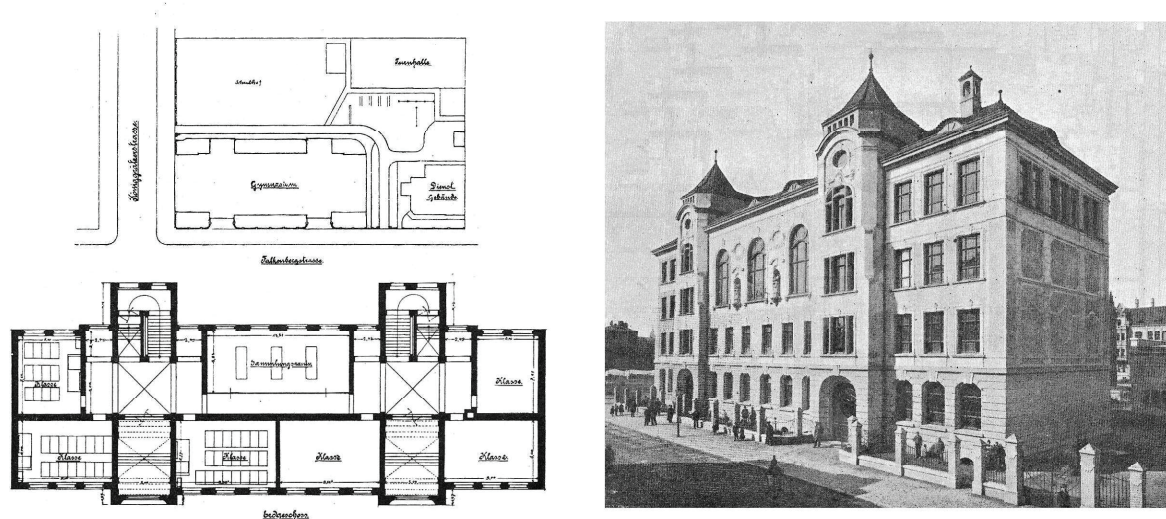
König Wilhelm-Gymnasium in Magdeburg (Bj:1902; Lageplan, Grundriss und Ansicht): viergeschossiger Bau mit 18 Klassen auf Eckgrundstück. Turnhalle (im Nordwesten) und Dienstwohnung (durch Hofeinfahrt getrennt, im Westen) befinden sich auf demselben Grundstück. Einfriedung: Falkenbergstraße (vorne): Zaun mit Sockel, Königgrätzerstraße (Schulhof): durchbrochene Mauer mit Dachsteinen abgedeckt In: Das Schulhaus. S.334, 335 und 336. 1902. 4. Jahrgang. No. 7
